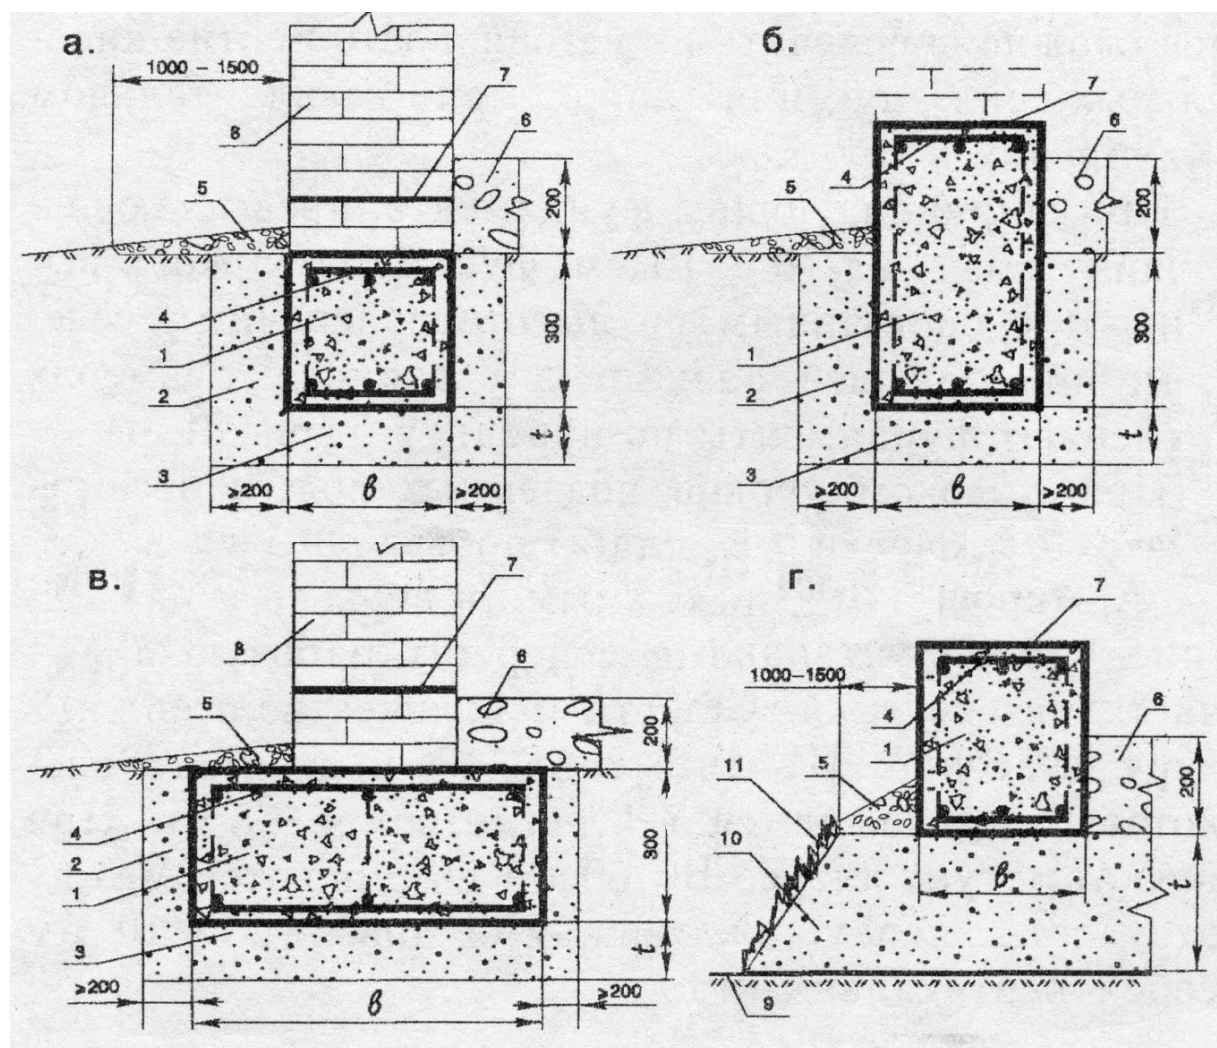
Варианты фундаментов мелкого заложения на пучинистых грунтах:
